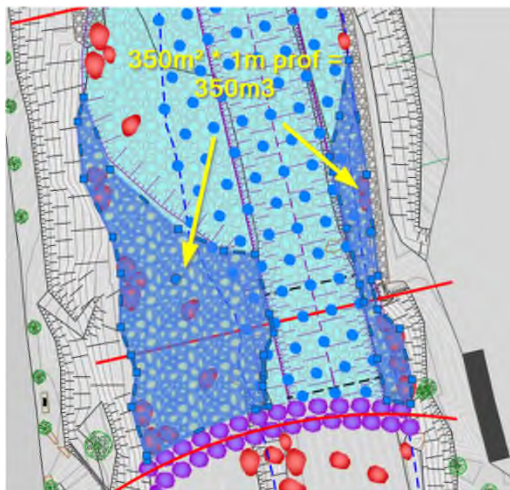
Vue en plan illustrant le volume de terrassement au droit des banquettes latérales présentes sur le tiers aval de la rampe
